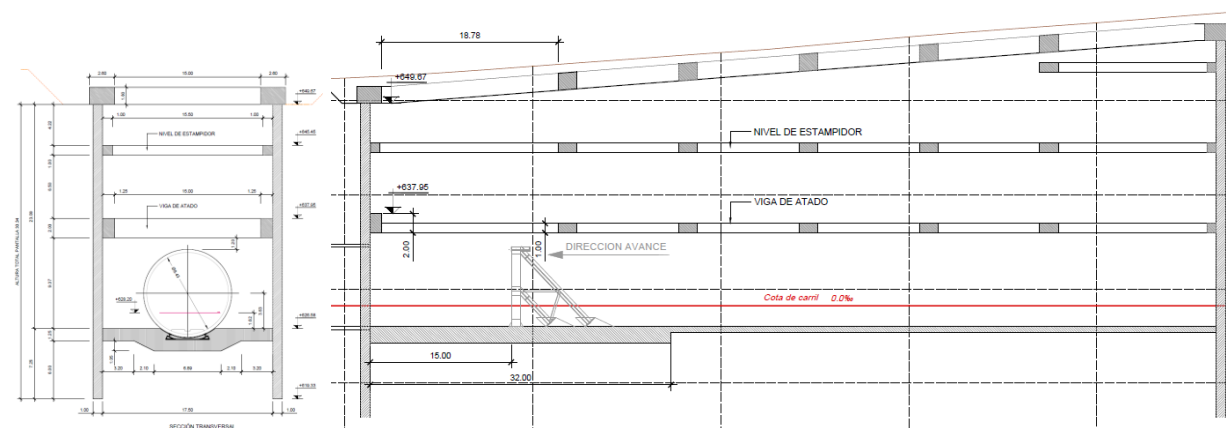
Sección transversal y longitudinal PAT-1 y PET-2 (Alt. 1-3)
